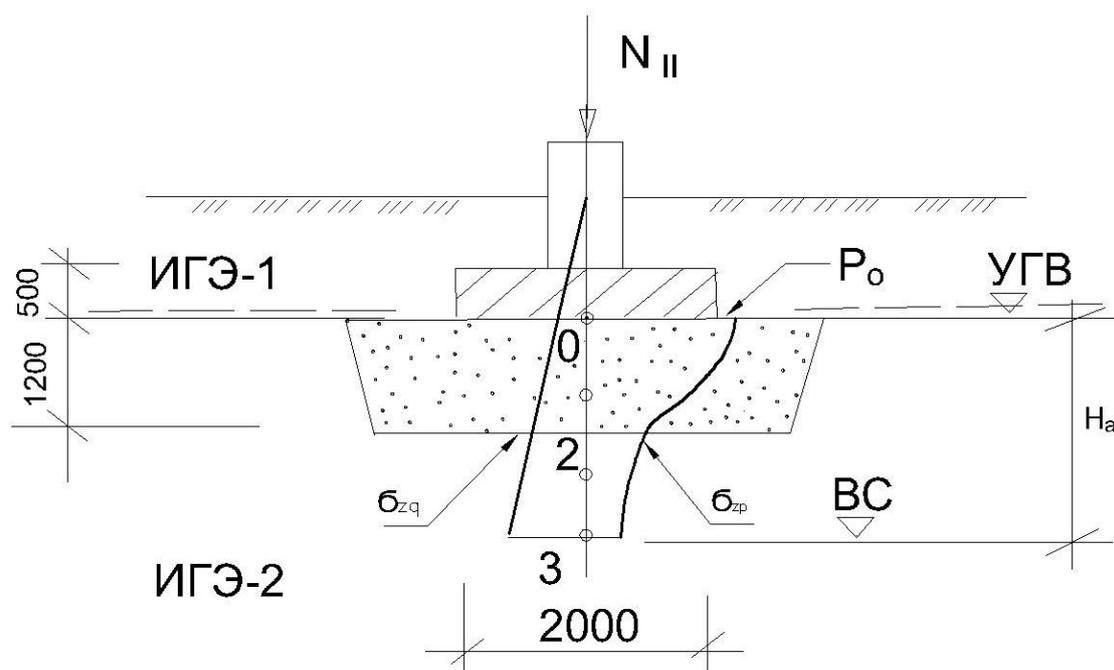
Расчетная схема ленточного фундамента на песчаной подушке
